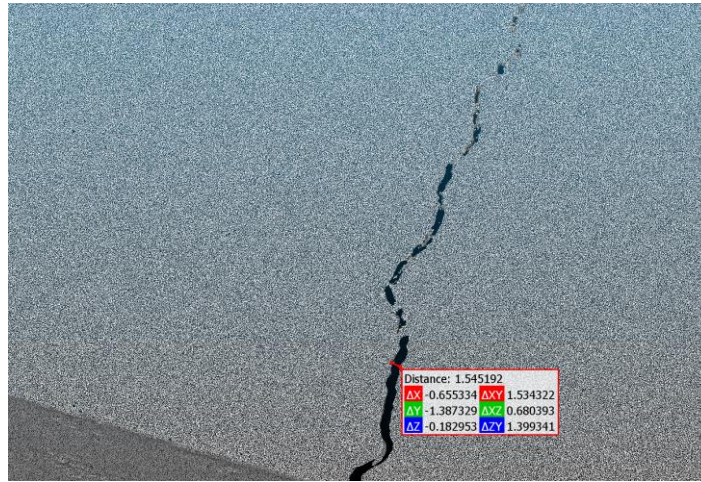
54 : Fissure principale de la poutre avec liaison confinée à 25 mm de flèche
